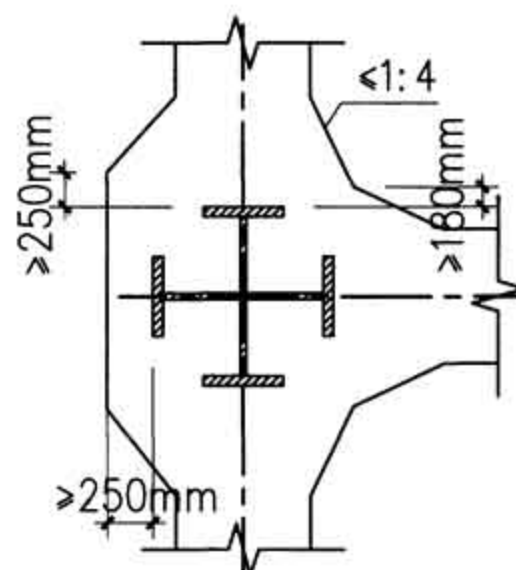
型钢混凝土柱型钢及钢筋保护层要求
